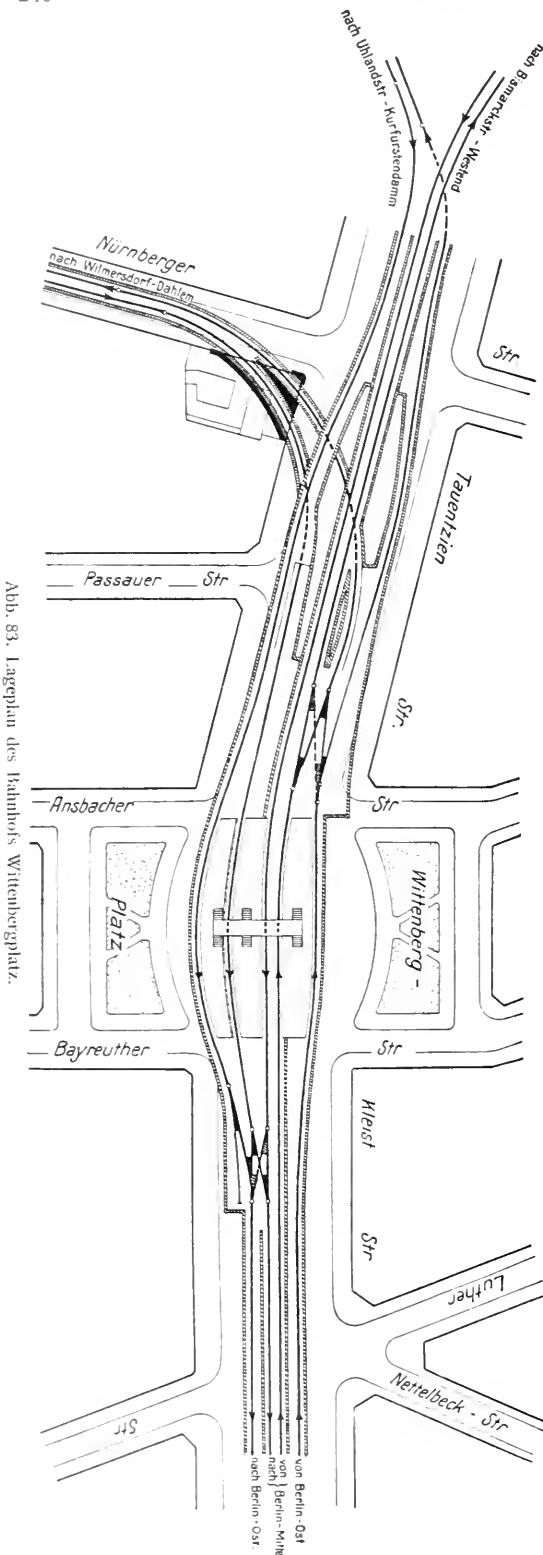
Lageplan des Bahnhofs Wittenbergplatz.
